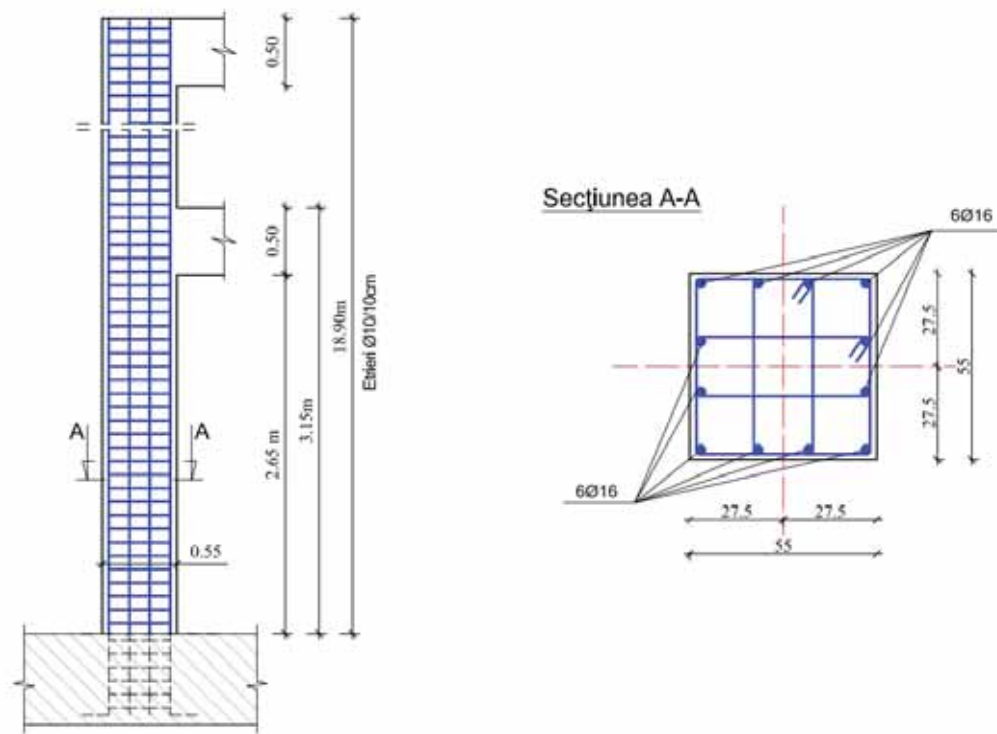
Structură P+5E: plan armare stâlp b.a.
